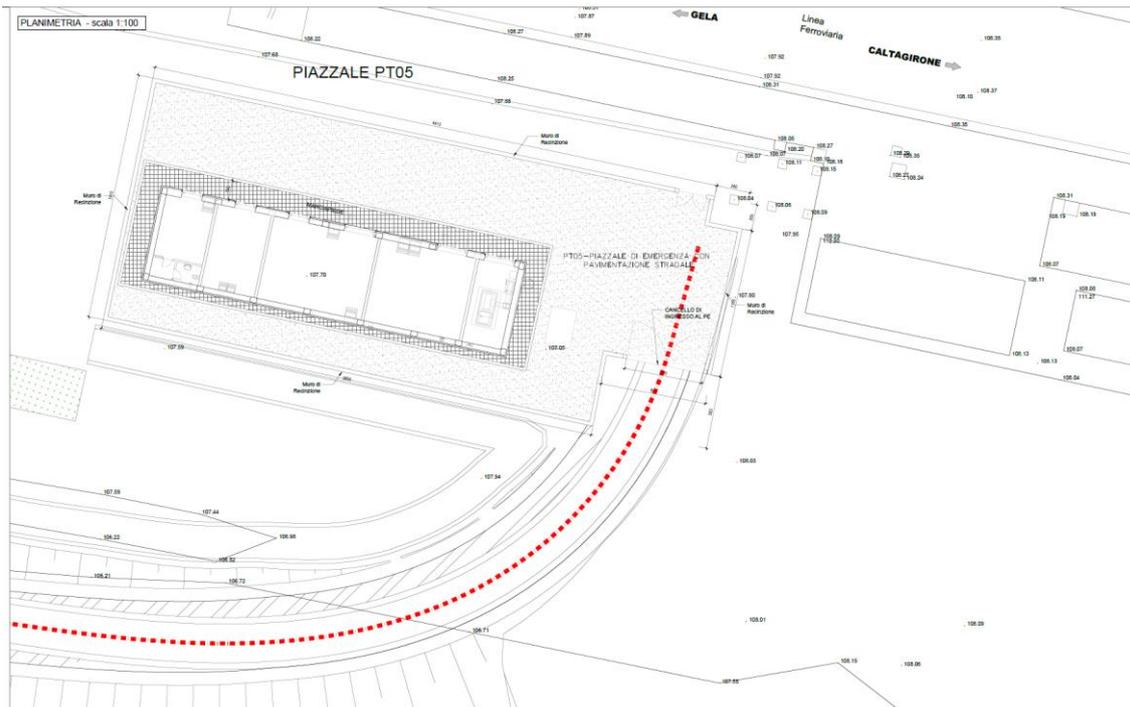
PT05 Planimetria piazzale GA del Buonfratello
